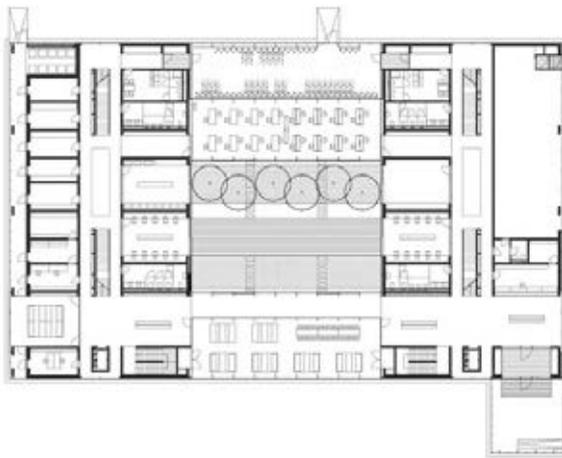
Viviendas para Estudiantes Poljane - Planta Baja.
